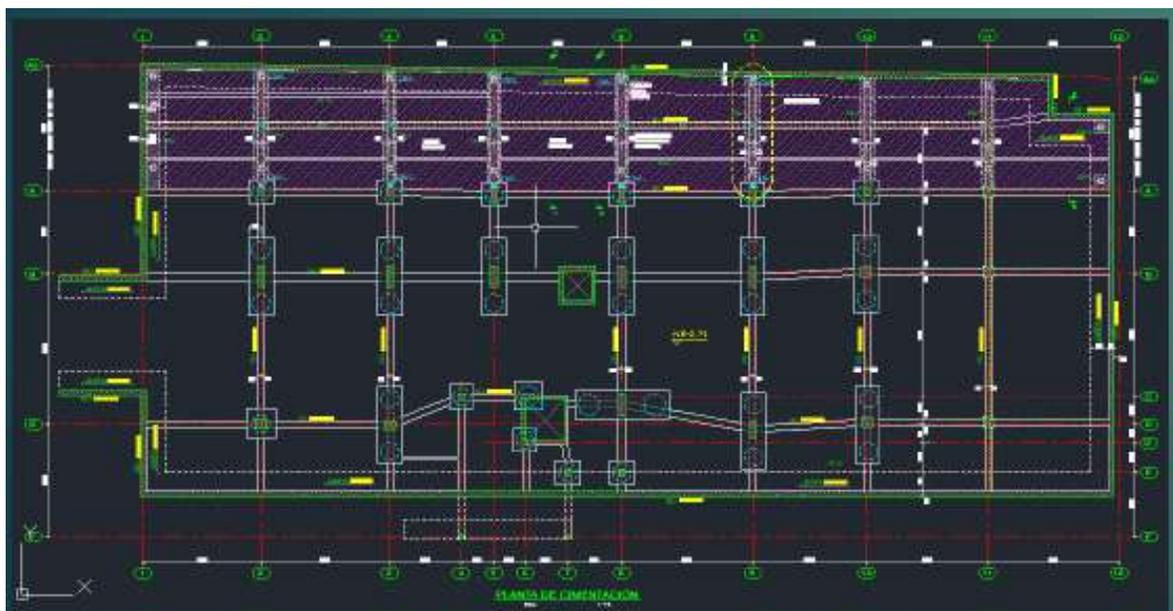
Planta sótano. Ubicación de los micropilotes
